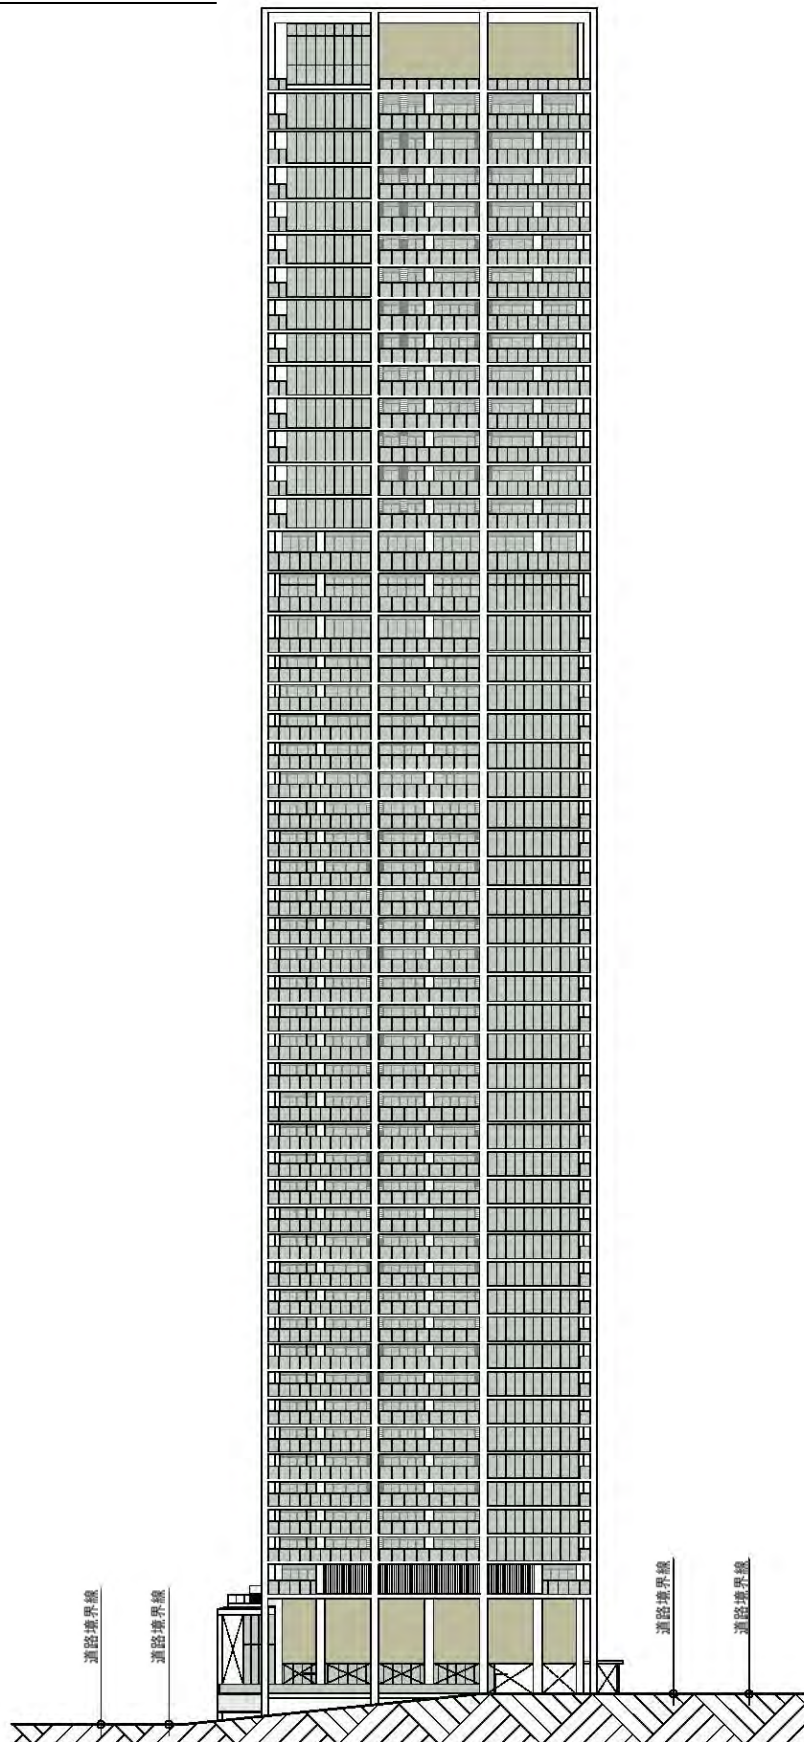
(1) 立面図 (北立面図 S=1:1,000)
